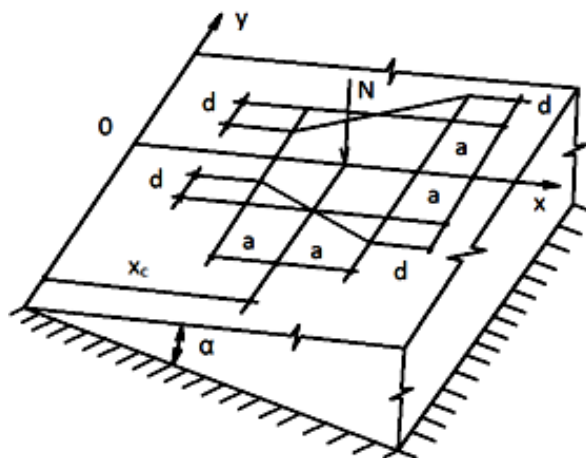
Расчетная схема для квадратного фундамента с эксцентричной нагрузкой
